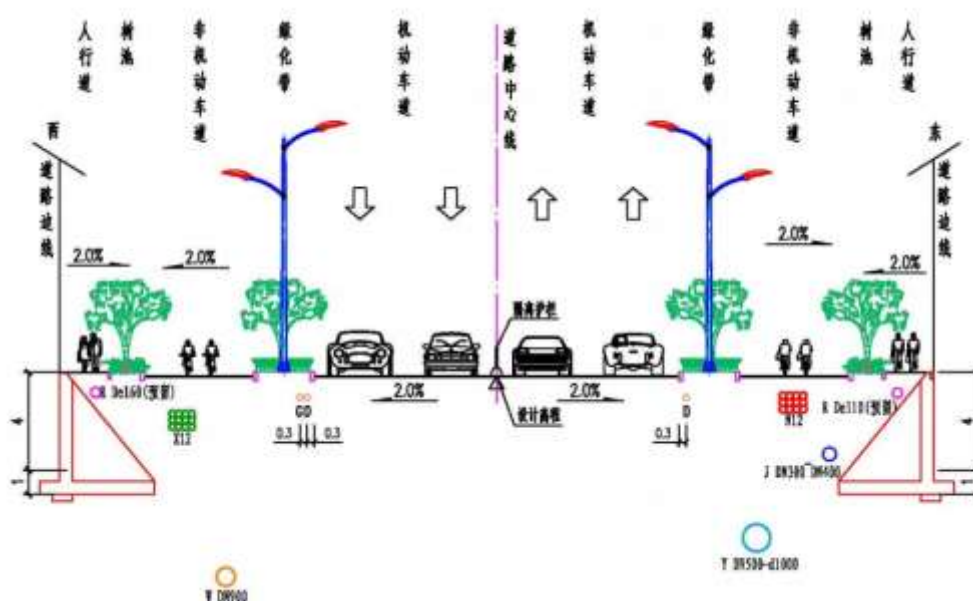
管线综合标准横断面图 (K0+600~K0+848)
